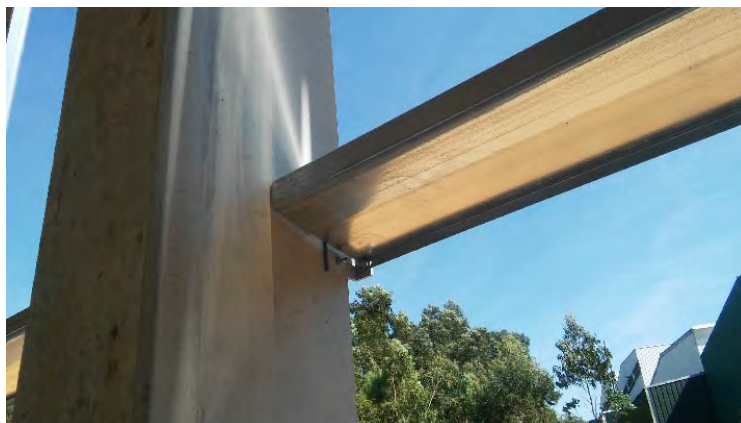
Pormenor de ligação dos perfis à estrutura porticada de betão.
